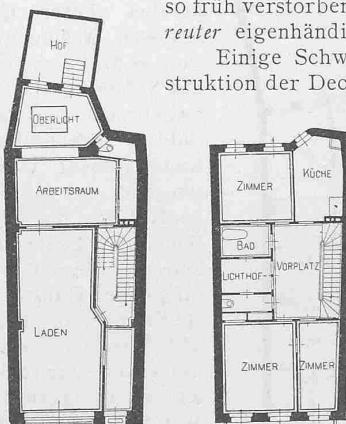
Das Haus «Zur Schwanenau». Grundrisse vom Erdgeschoss und II. Stock. Maßstab 1:400.
